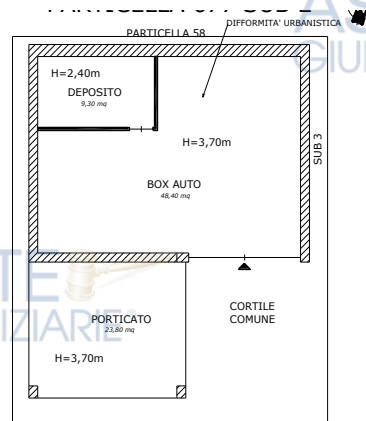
planimetria delle difformità urbanistiche del porticato al piano terra
